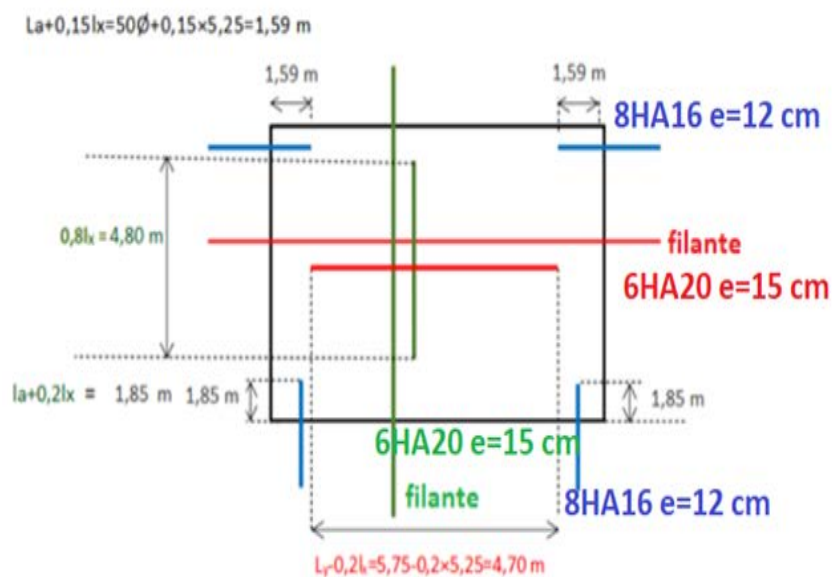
Schéma de ferrailage de la dalle du radier, y compris les arrêts des barres
